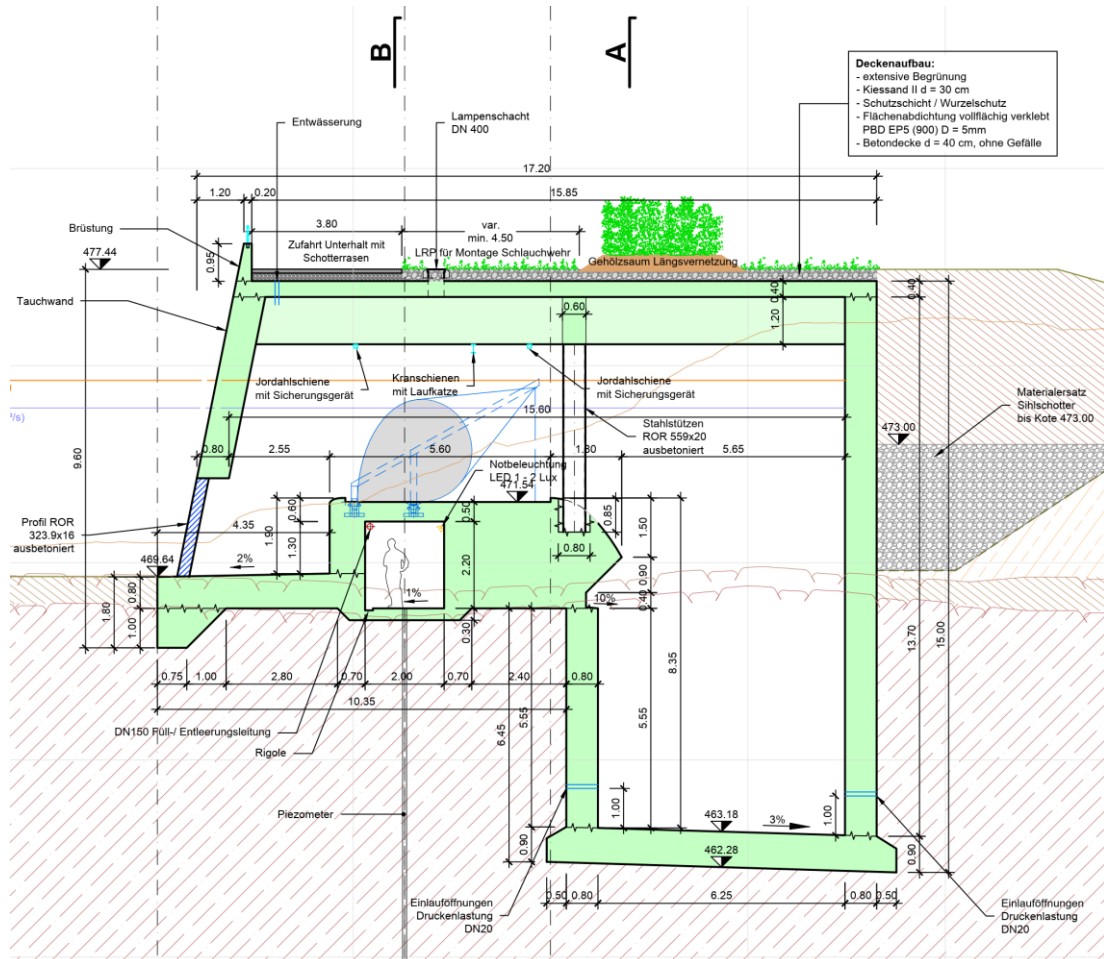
Querschnitt Einlaufbauwerk mit Tauchwand, Rechen, Kontrollgang, Überfallkrone mit Schlauchwehr, Überfallnase und Druckentlastungen
